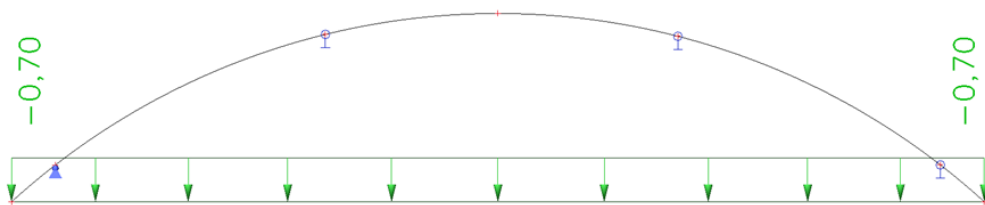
Zatížení střešní konstrukce – střešní plášť
